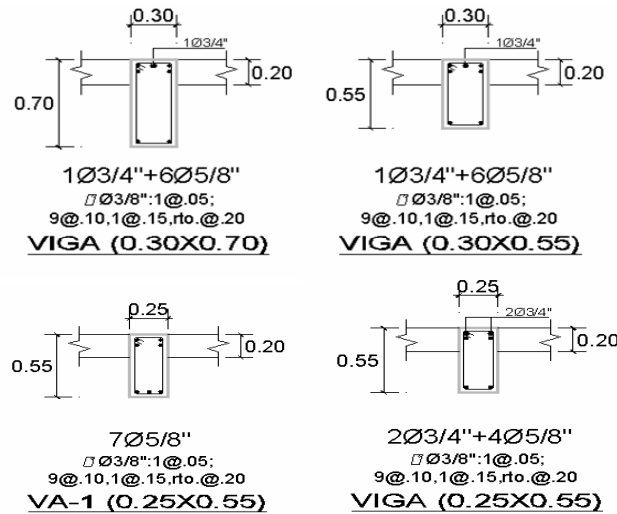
Detalle del refuerzo de las vigas (Edificio 780 actual)
